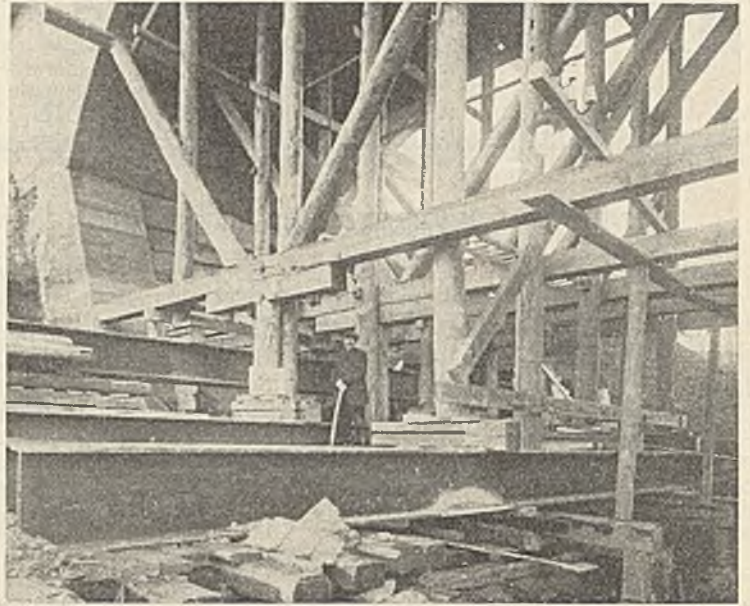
Abfangung des Lehrgerüsts zur Ausführung der darunterliegenden Eisenbetonsteifbalken.
